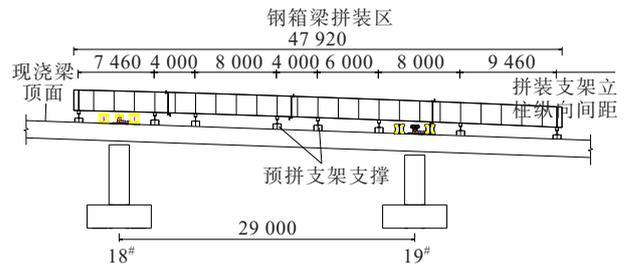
钢箱梁拼装支架纵断面布置图(单位:mm)
